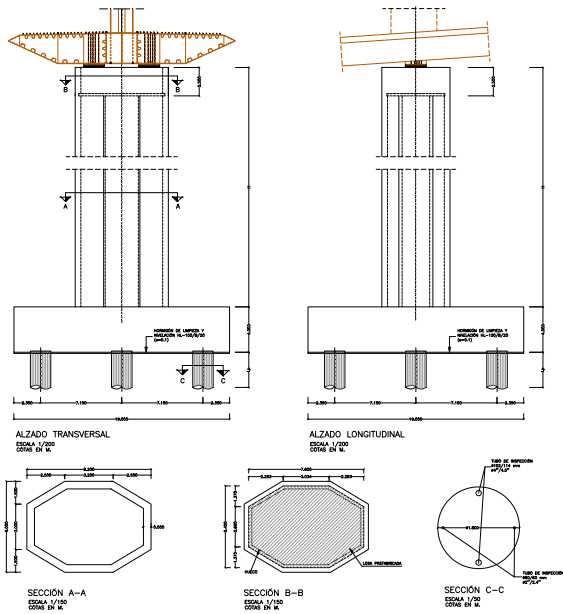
Detalles de las pilas principales sobre los que se apoyan los pilonos metálicos.
